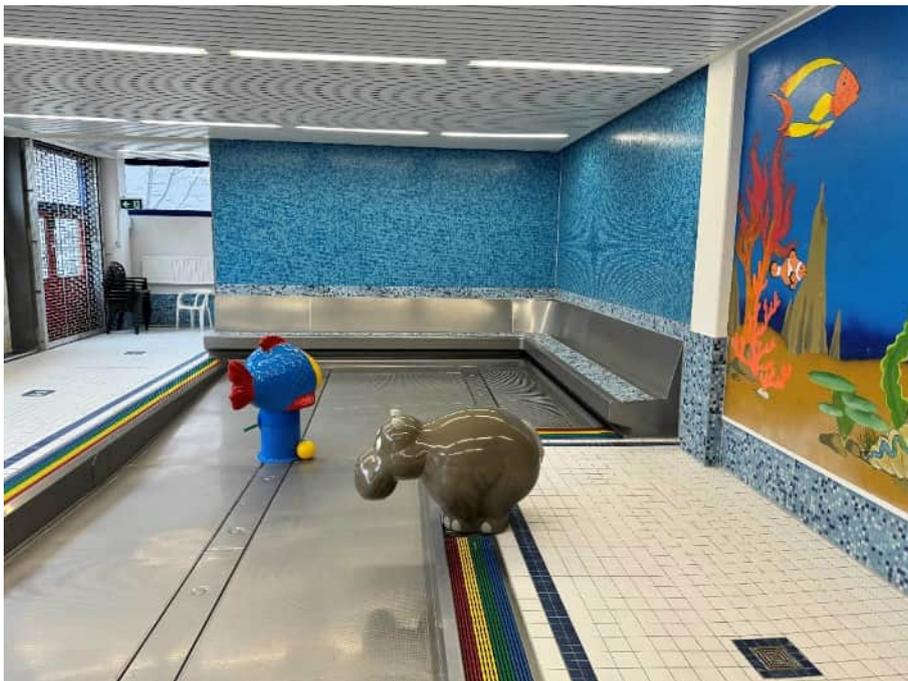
EG Beckenbereich – Planschbecken
